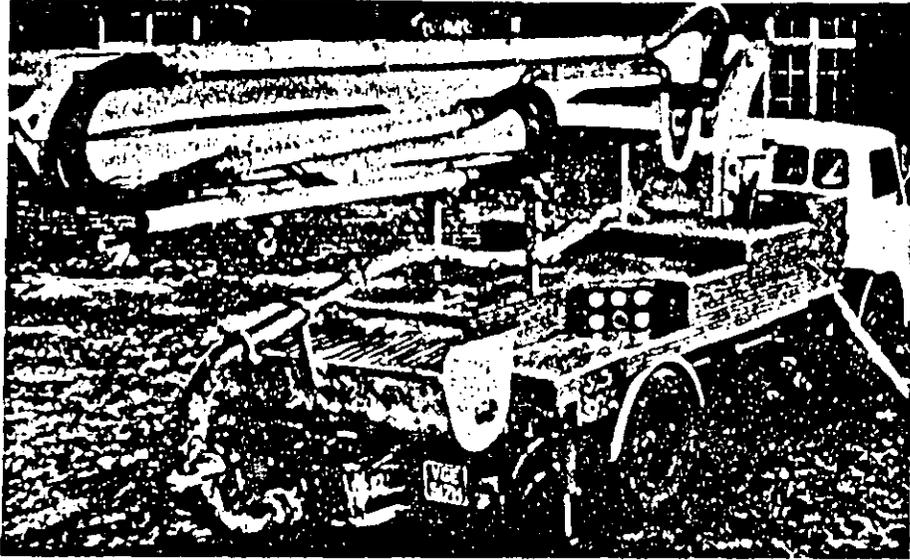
Bomba montada por completo en un camión, con pluma de colado plegable.
